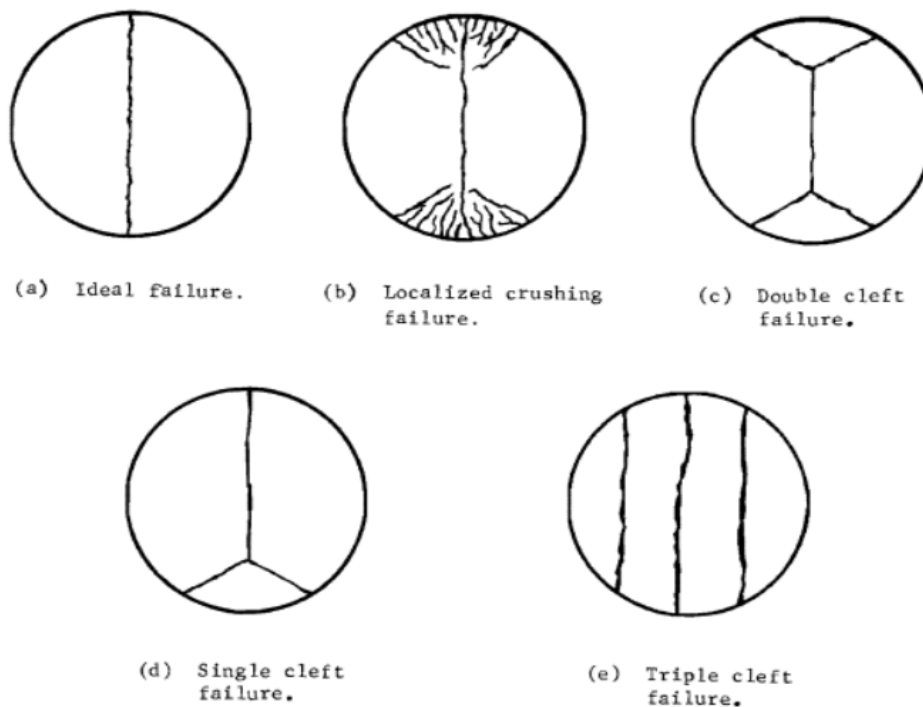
3. Diversi tipi di Rottura che possono manifestarsi durante la prova ITS.
